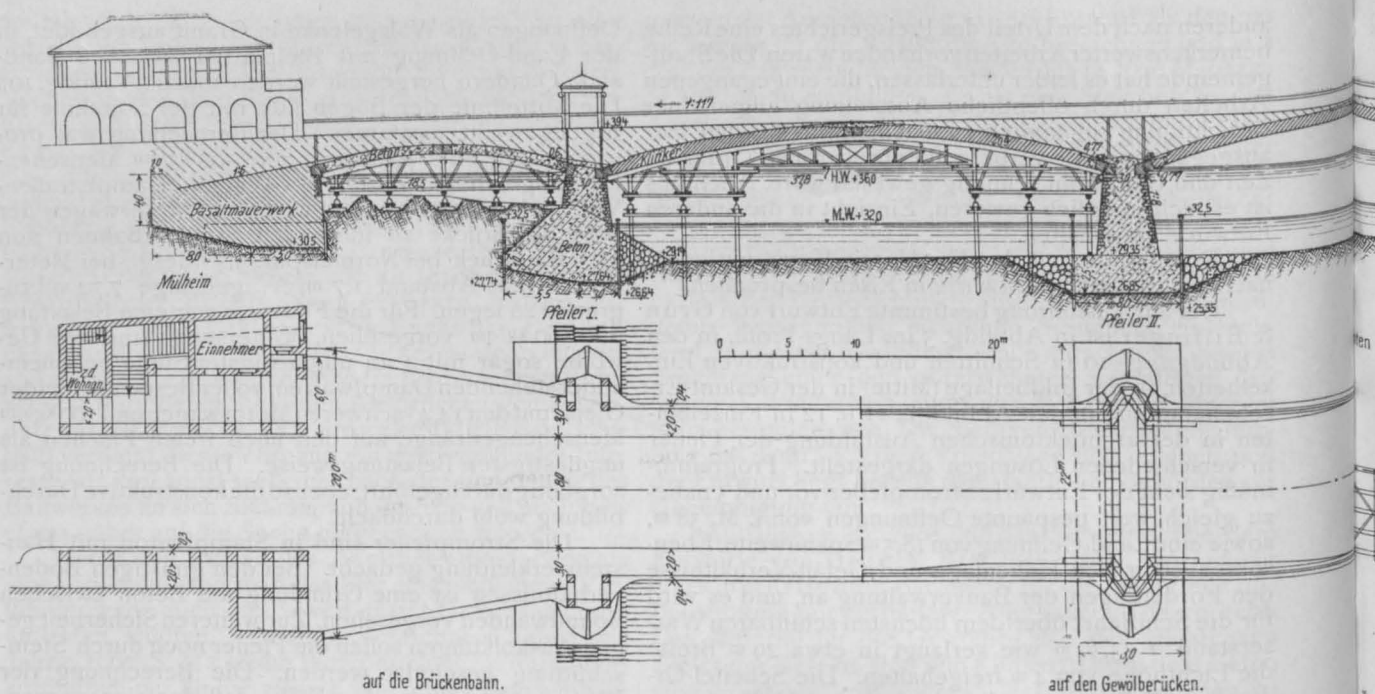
und 5. Längsschnitte und Grundrisse.
